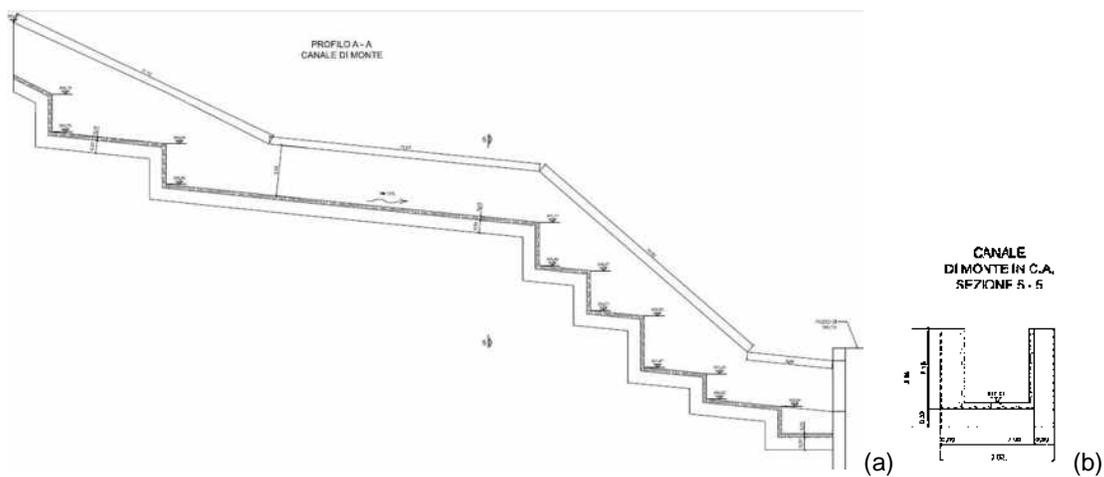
Fosso Nicolino, canale di monte: (a) sezione longitudinale e (b) sezione trasversale
